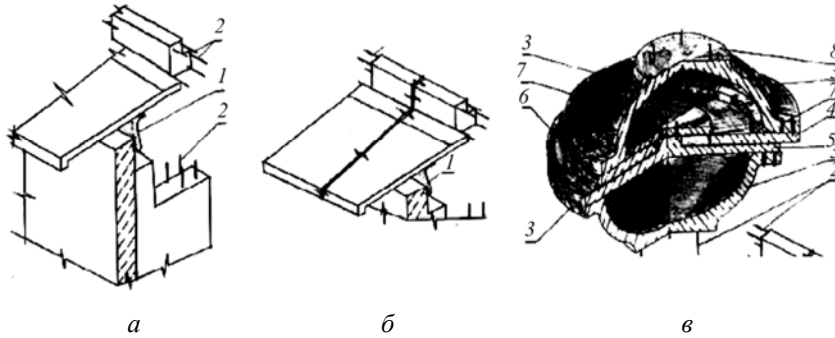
Практический вариант комплексного решения системы сейсмозащиты со скользящим поясом (конструкции инженера Н. В. Мартынова): *а* — элементы фундамента или этажа установки сейсмоизолирующего узла; *б* — ригельная балка подвала или балка этажа установки сейсмоизолирующего узла; *в* — сейсмоизолирующий узел: 1 — гибкая тепло-изоляционная защита фундамента здания или сооружения; 2 — анкерующие стержни конструкций и стержни крепления сейсмоизолирующего узла; 3 — опорные оболочки сейсмоизолирующего узла; 4 — двутавровая и 5 — кольцевая опорные пластины; 6 — фрикционные элементы; 7 — обечайка; 8 — опорная площадка для установки ригельных балок
